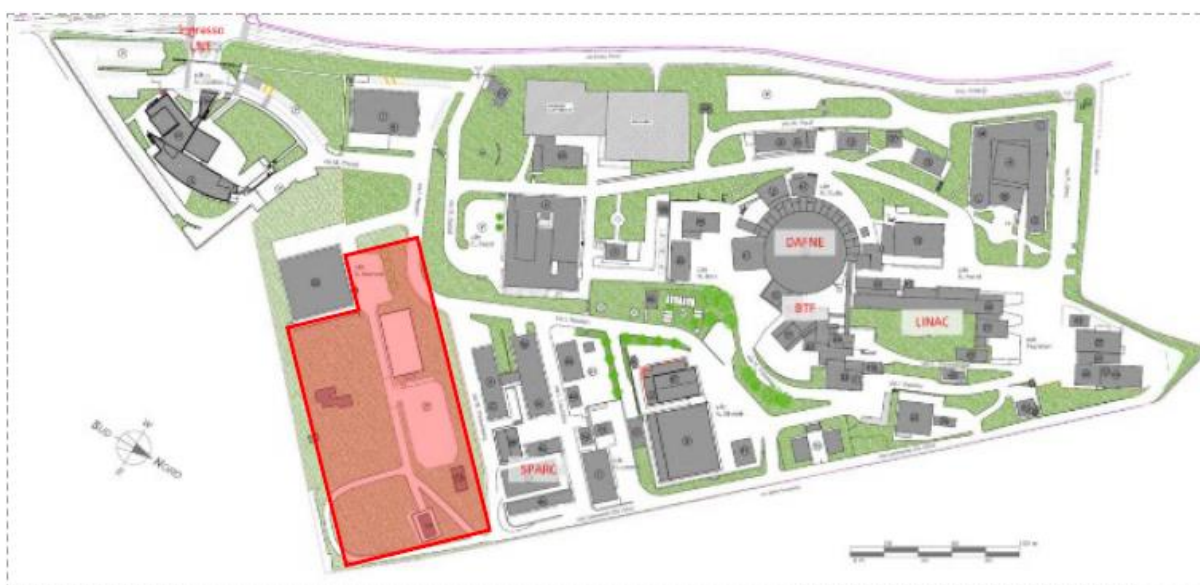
Planimetria generale dei Laboratori Nazionali di Frascati INFN con evidenziata l'area oggetto di intervento.
